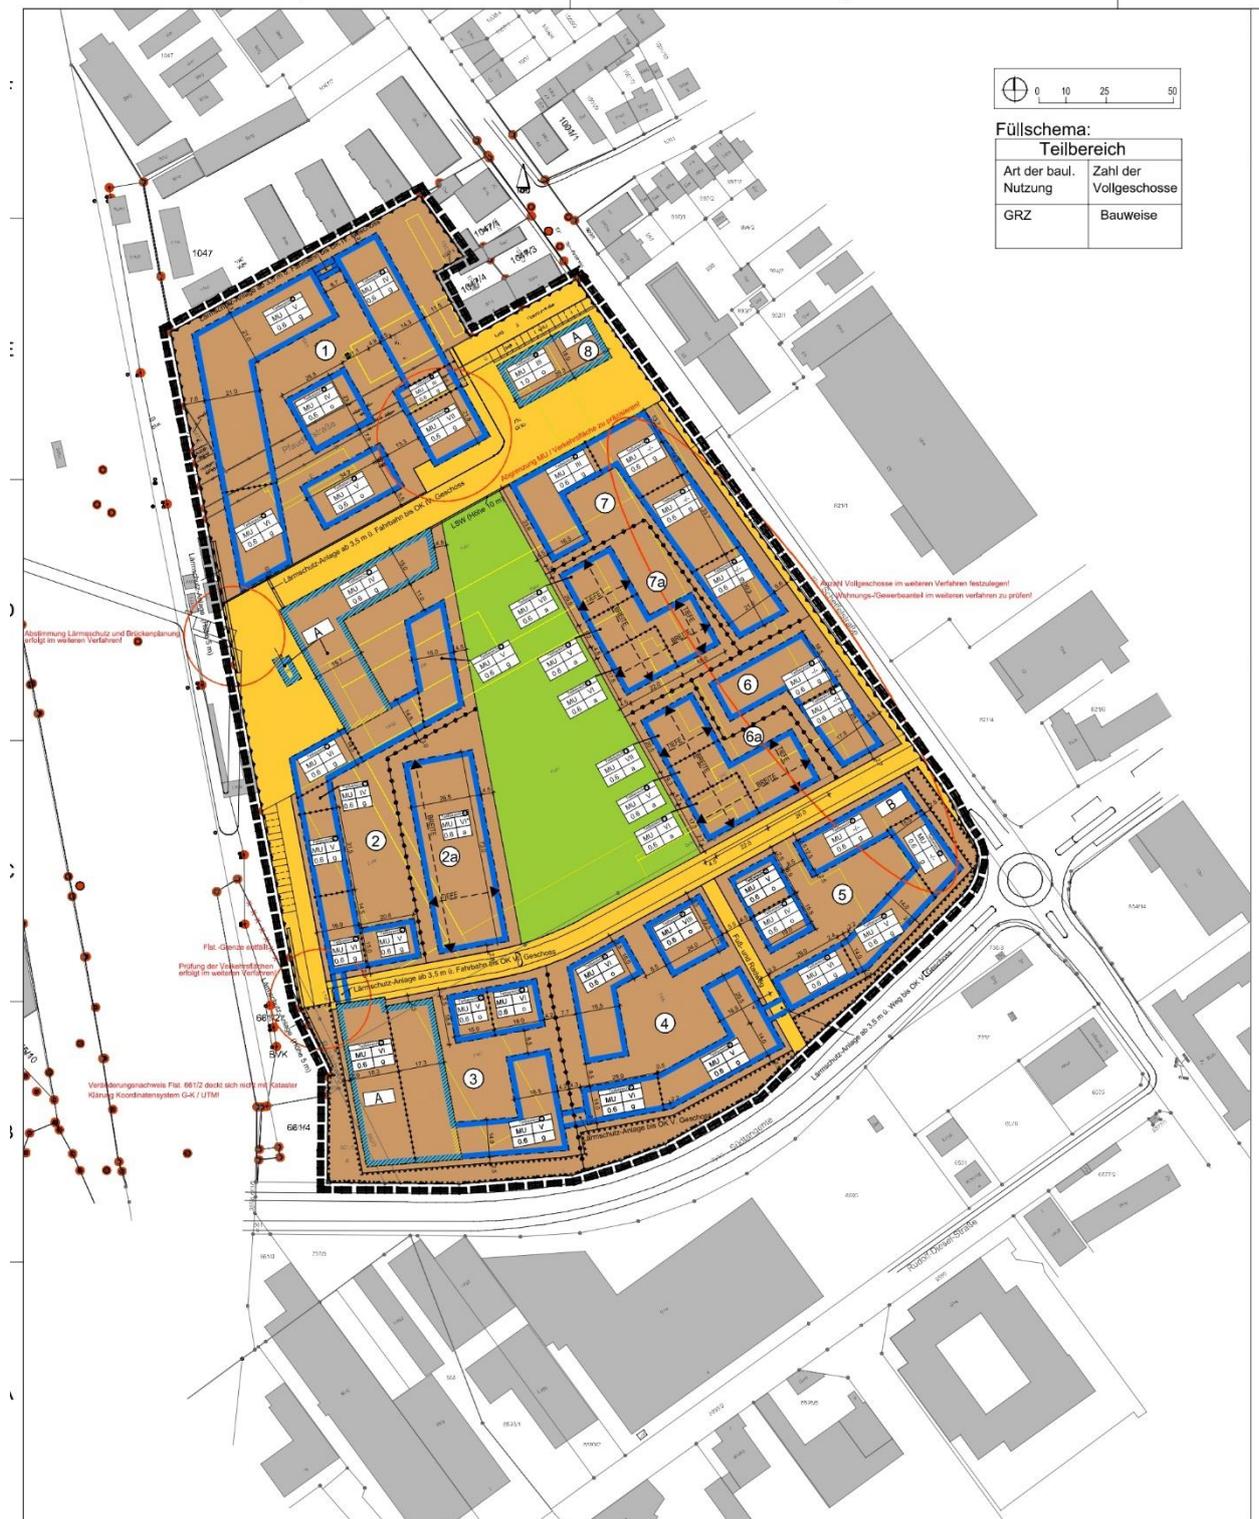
Bebauungsplan „Schwetzinger Höfe“
